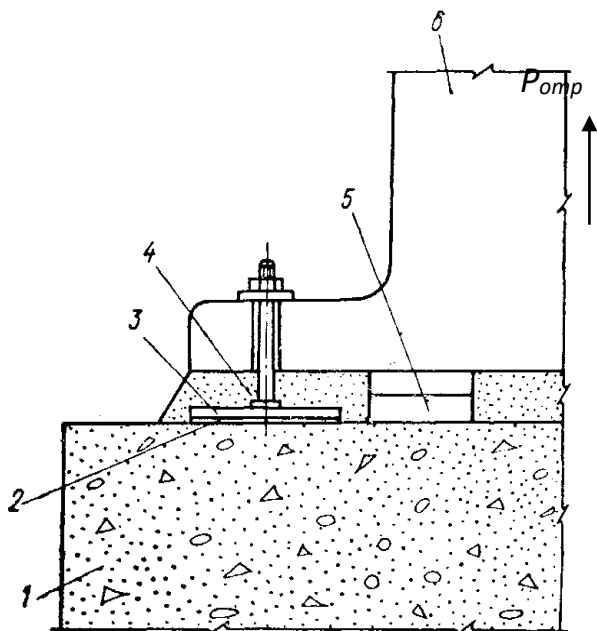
Схема безанкерного крепления оборудования на готовых фундаментах: 1 – фундамент, 2 – клеевой слой, 3 – узел крепления, 4 – подливка, 5 – монтажные подкладки, 6 – оборудование
